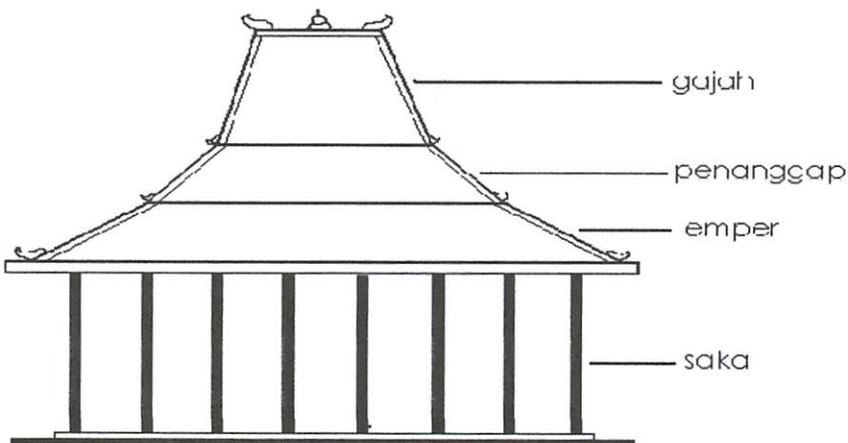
Tampak samping bangunan tipe joglo
